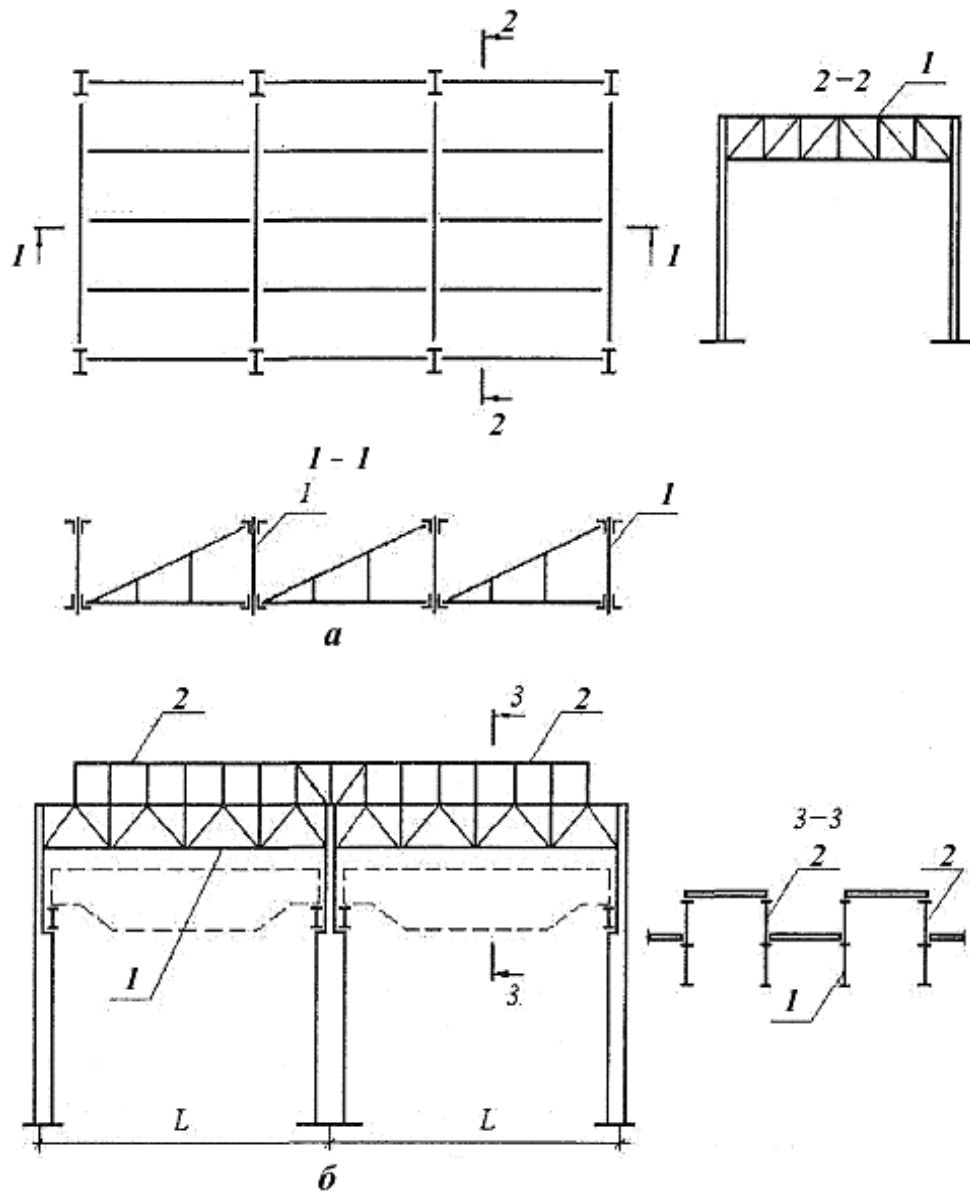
Конструктивні схеми каркасів з підвищеними вимогами до освітлення: *a* – з шедовим покриттям; *б* – з поперечним ліхтарем; 1 – ферми, 2 – ліхтар
